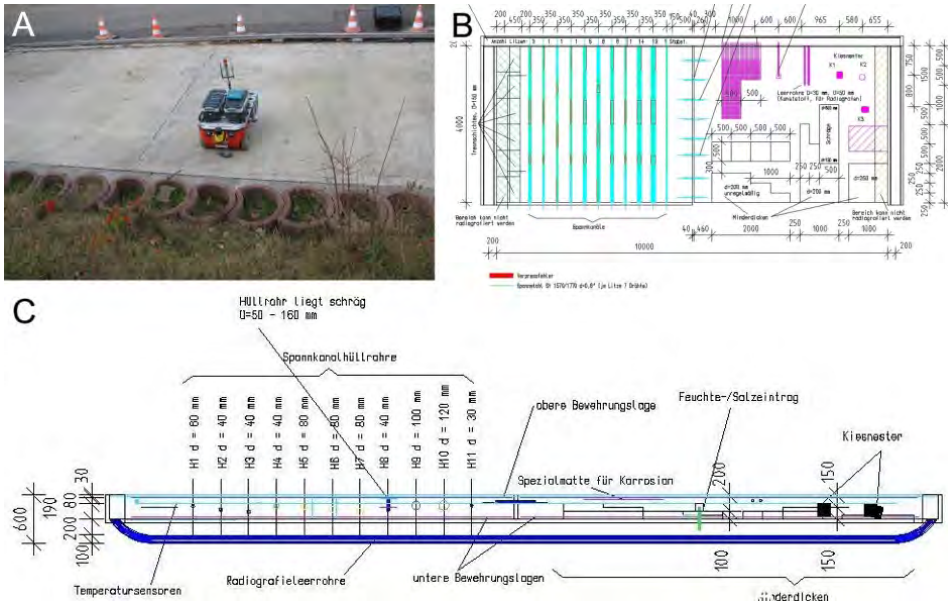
A: Großer Betonprobekörper mit Roboterplattform, B: Grundriss mit Einbauten, C: Querschnitt
